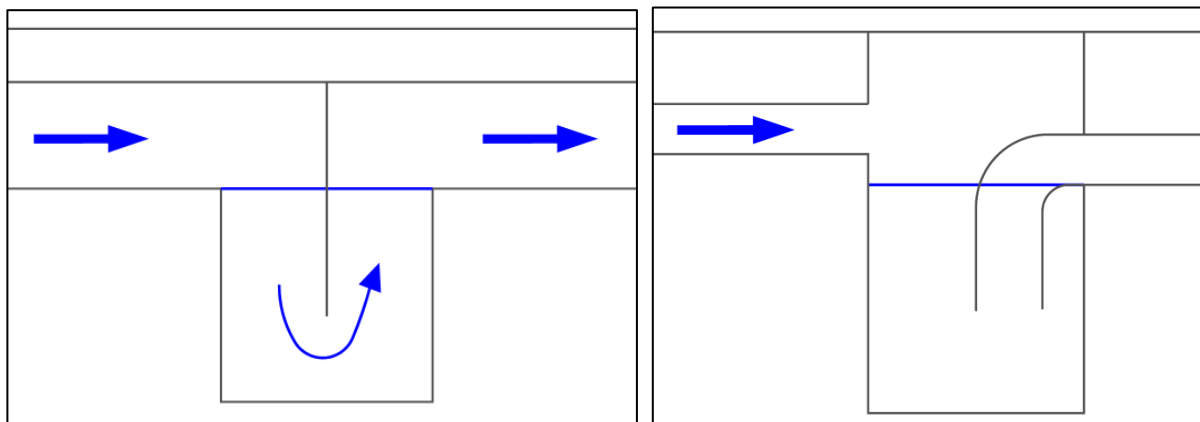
Schémas de principe de 2 exemples de zones de décantation (cloison siphonoïde et coude PVC)
